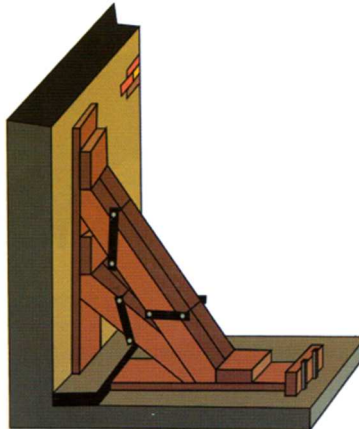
Apeo inclinado de orden doble y apoyo simple
